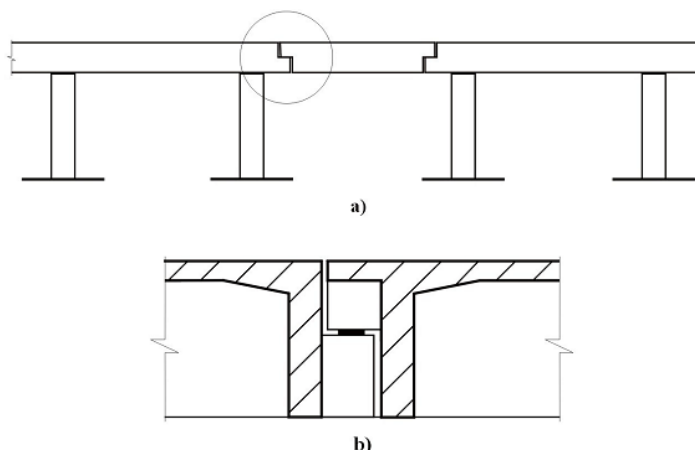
Ponte em vigas simplesmente apoiadas com diversos vãos:
